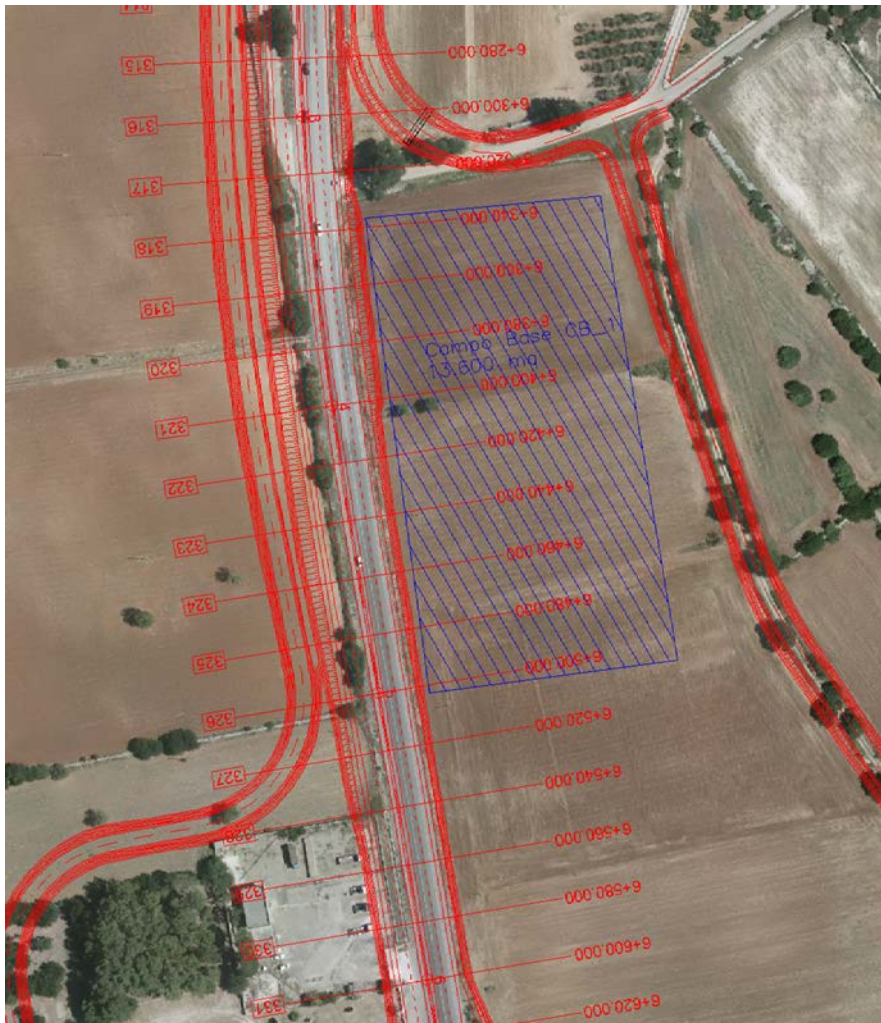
Superficie occupata dal Cantiere Base CB_1
